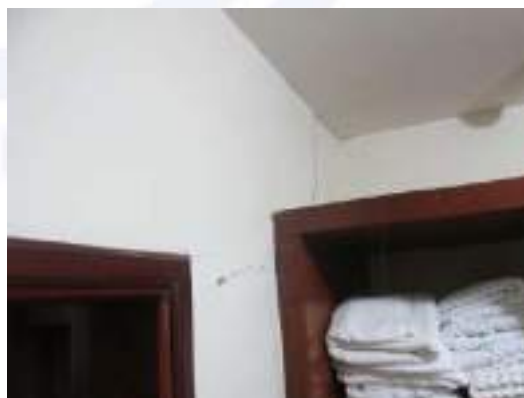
Fisura en mampostería a través de la mampostería eje e.
